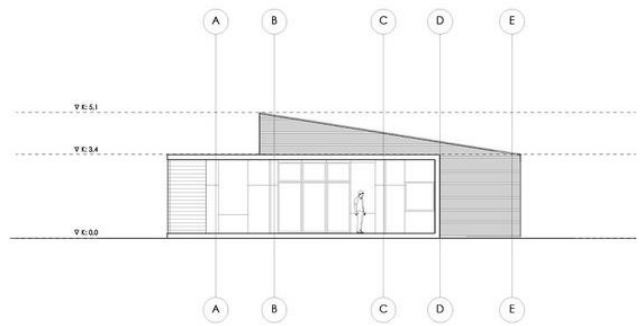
y 148. Alzado Sur y Oeste (ArchDaily, 2023).
